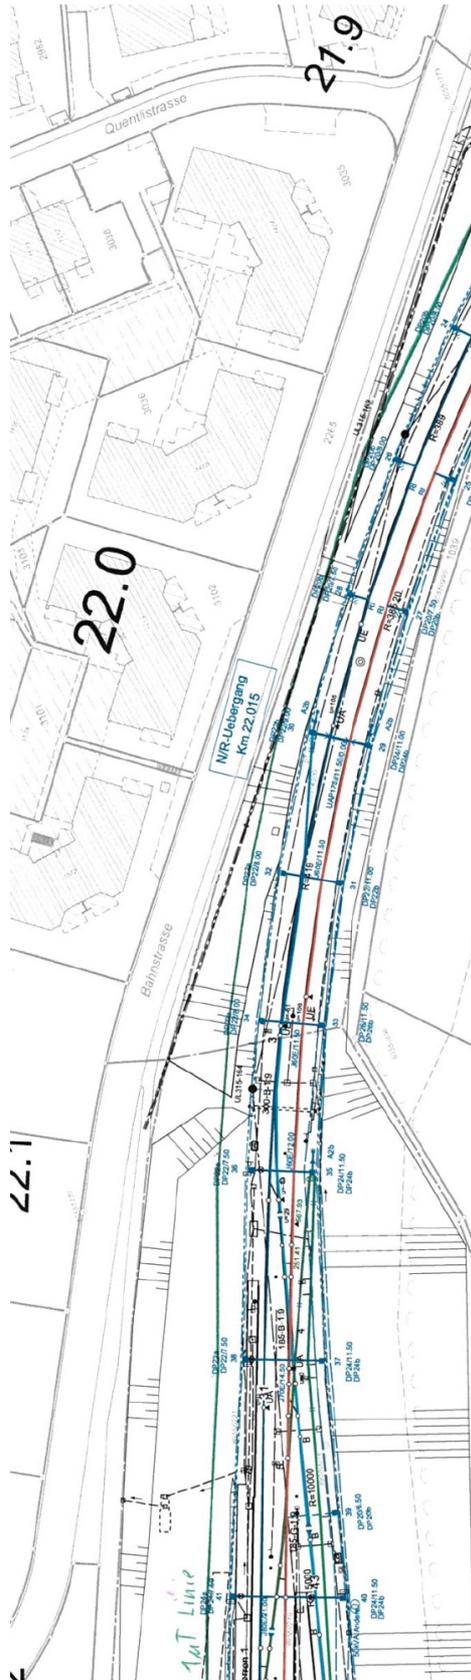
Auszug Situationsplan Fahrleitungen SBB, Kontrollabstand 1µT (grüne Linie), Quelle: SBB, 16.10.2014
